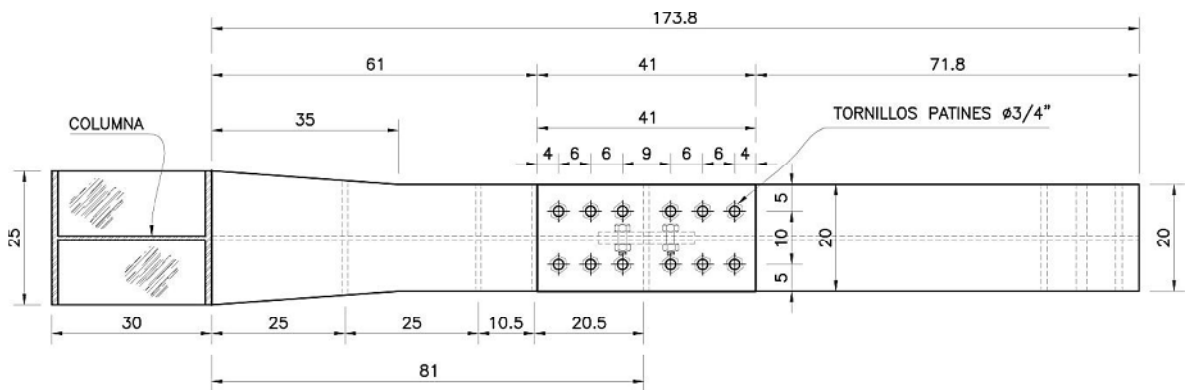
Vista en planta de la conexión tipo ÁRBOL, modelo BFP4
